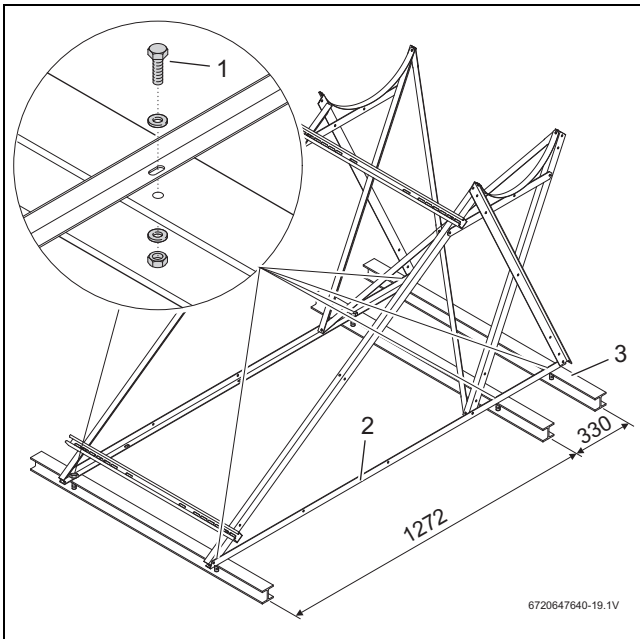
Soporte para tejado plano sobre viga en I, medidas en mm (sistema de 150/200 I)
